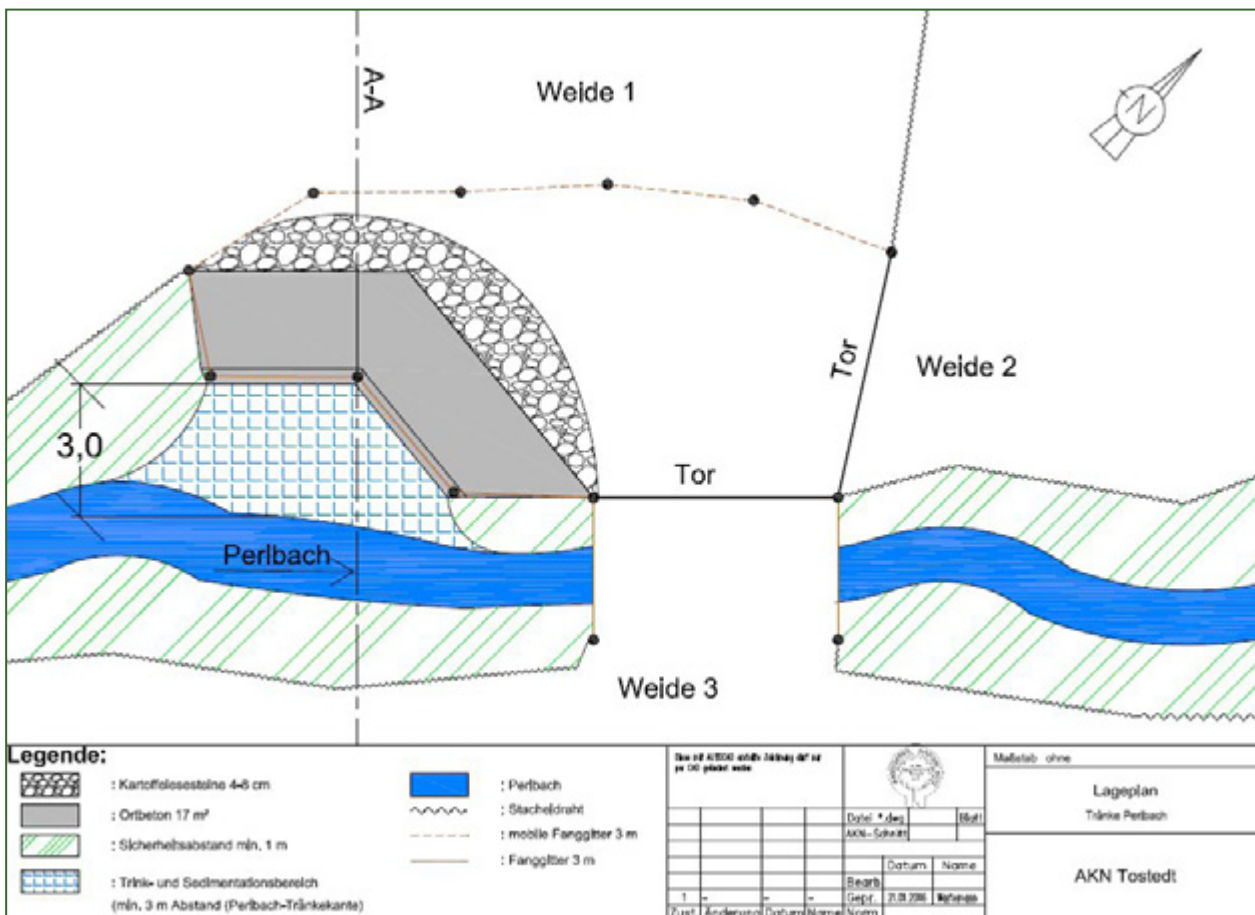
Grundriss einer geplanten Viehtränke am Perlbach
